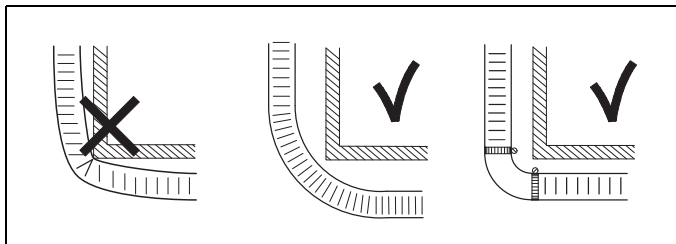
Рекомендуемая прокладка воздуховодов на углах
